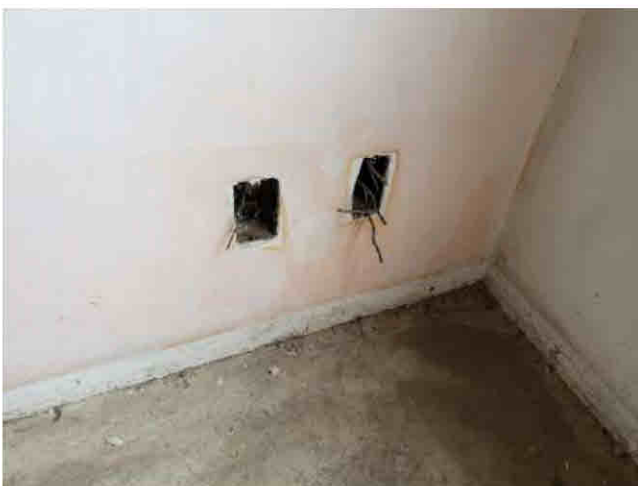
Detalhe para instalações elétricas incompletas e marcação da retirada do piso e rodapé
